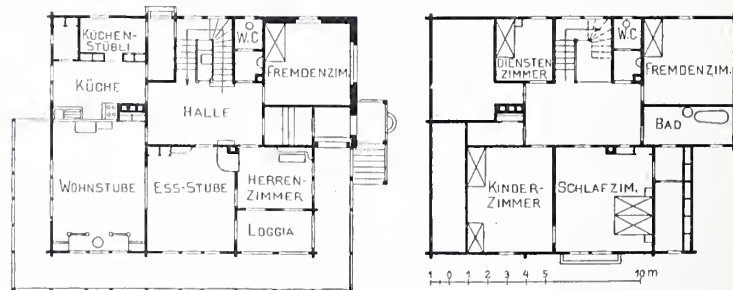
Grundrisse vom Erdgeschoss und Dachstock. — 1 : 400.
